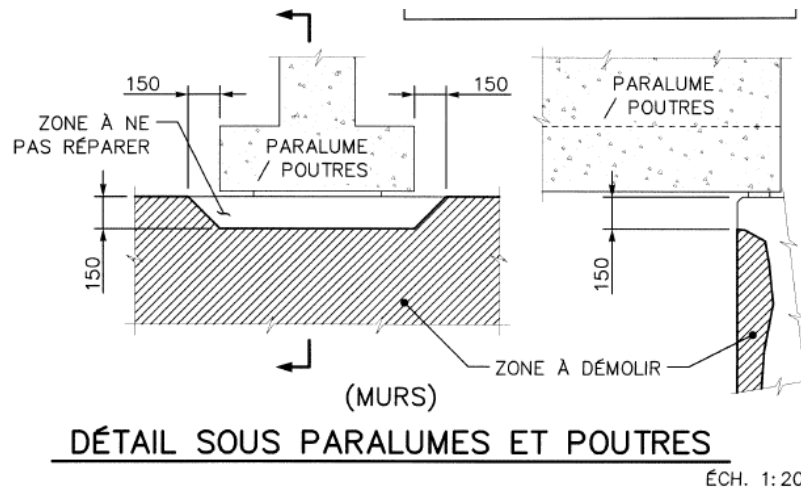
Extrait du plan P0-2010-1-15418 représentant la zone de démolition sous les poutres
